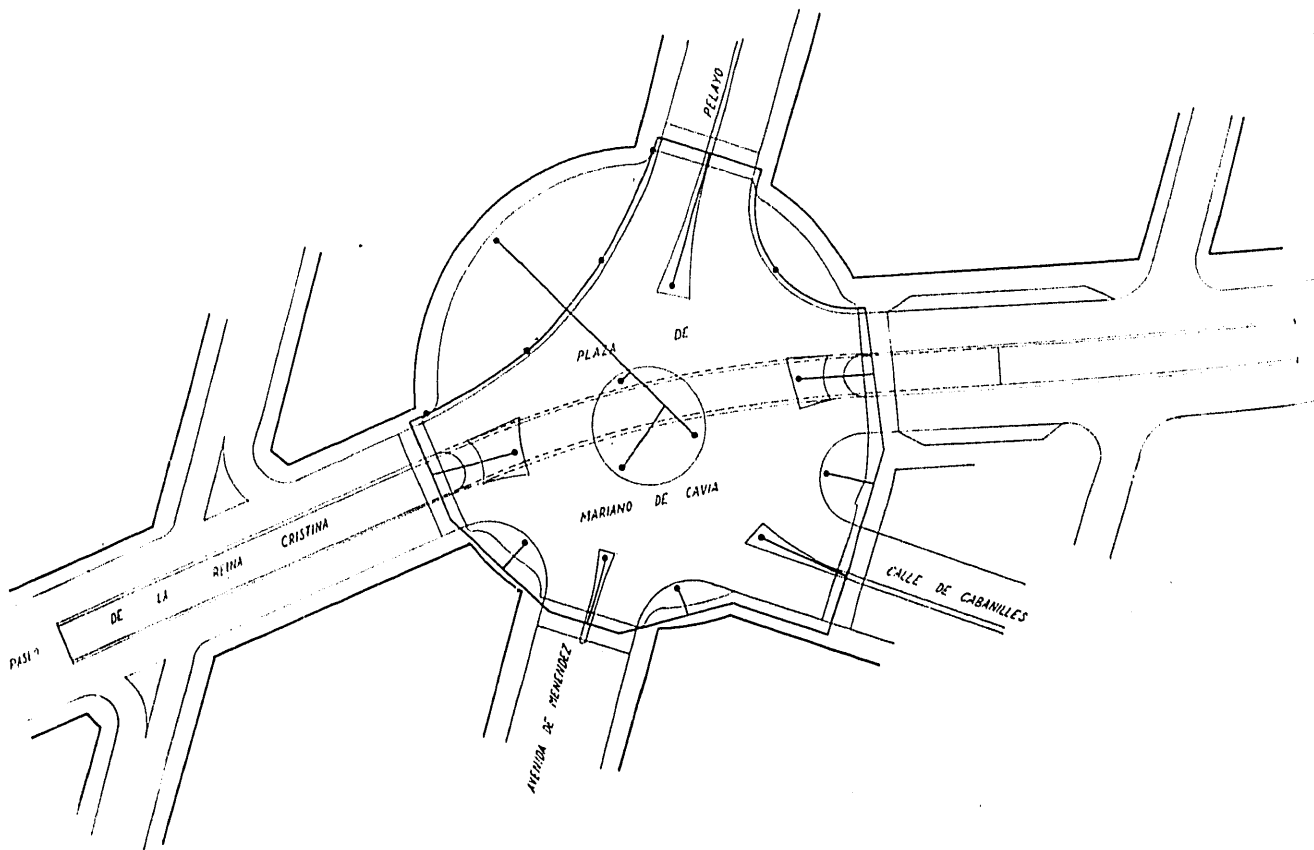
^a — Planta del paso subterráneo bajo Glorieta Mariano de Cavia.
